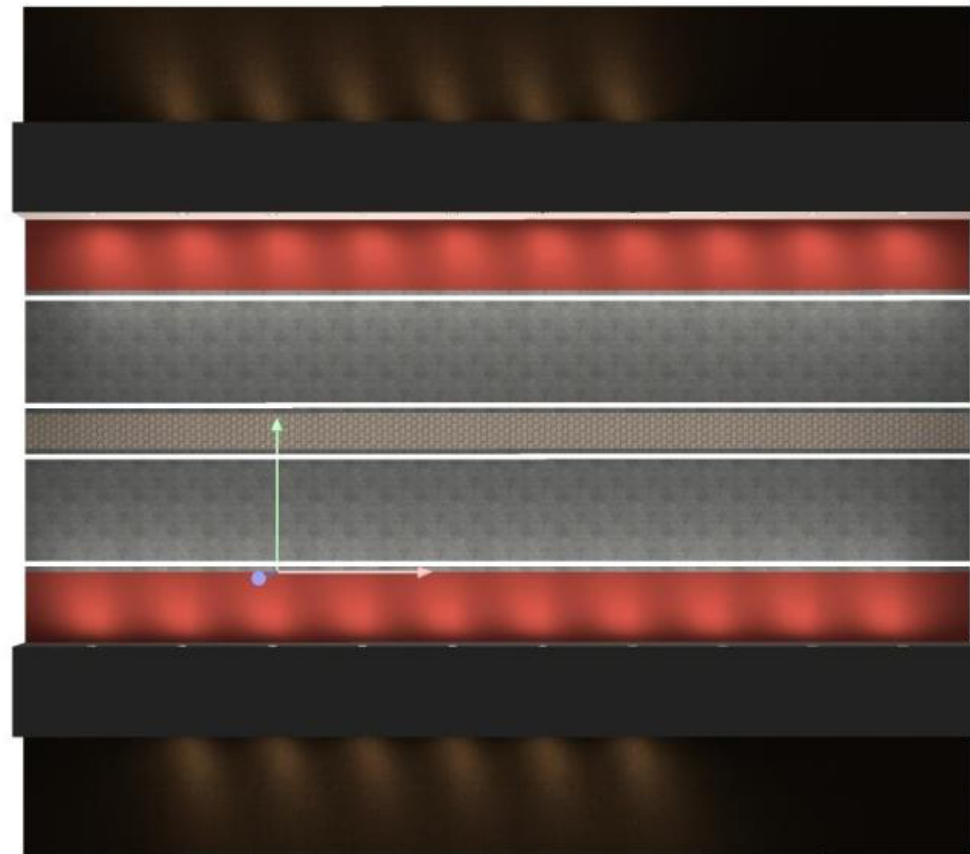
PLANTA DE LA ILUMINACIÓN DEL PUENTE
